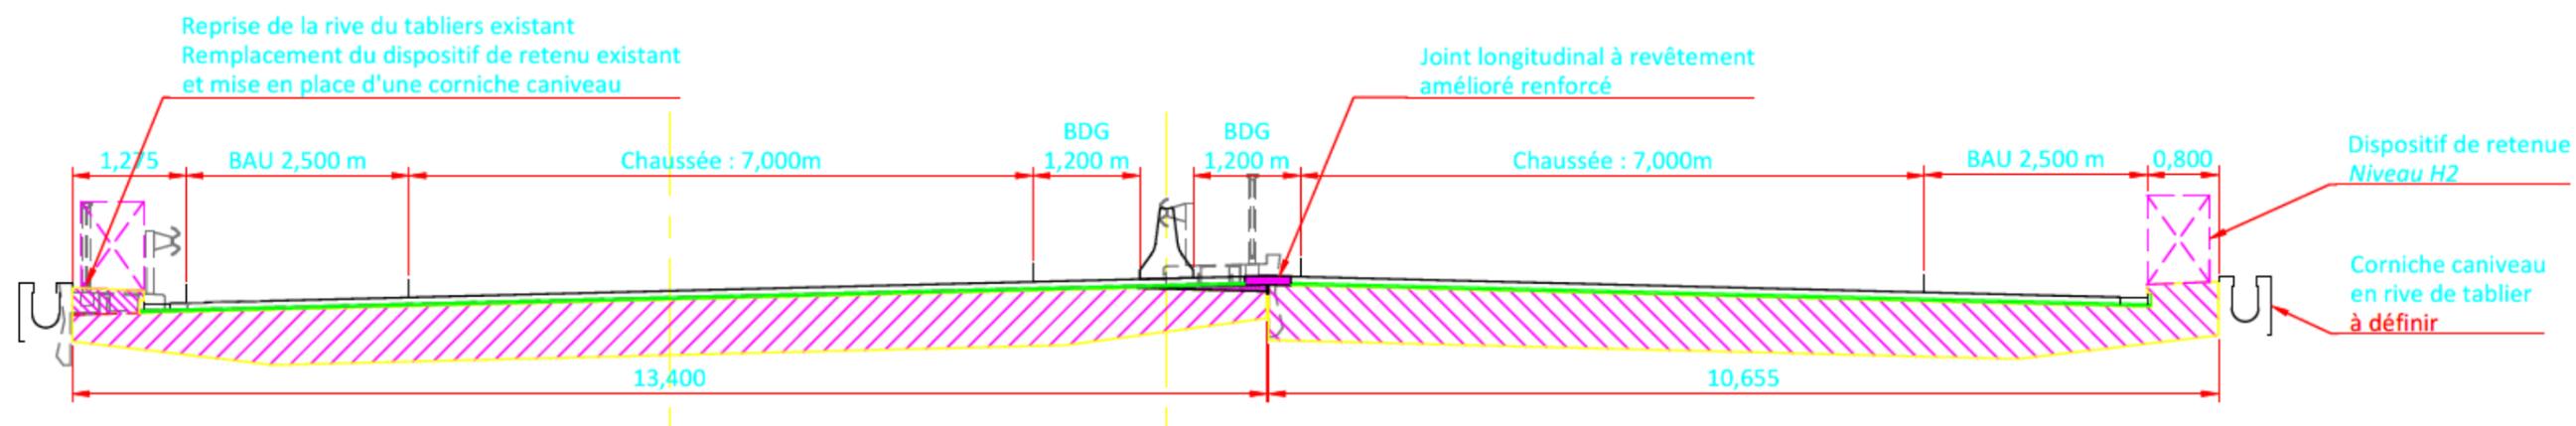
PI2 - Coupe transversale type de l'ouvrage futur
